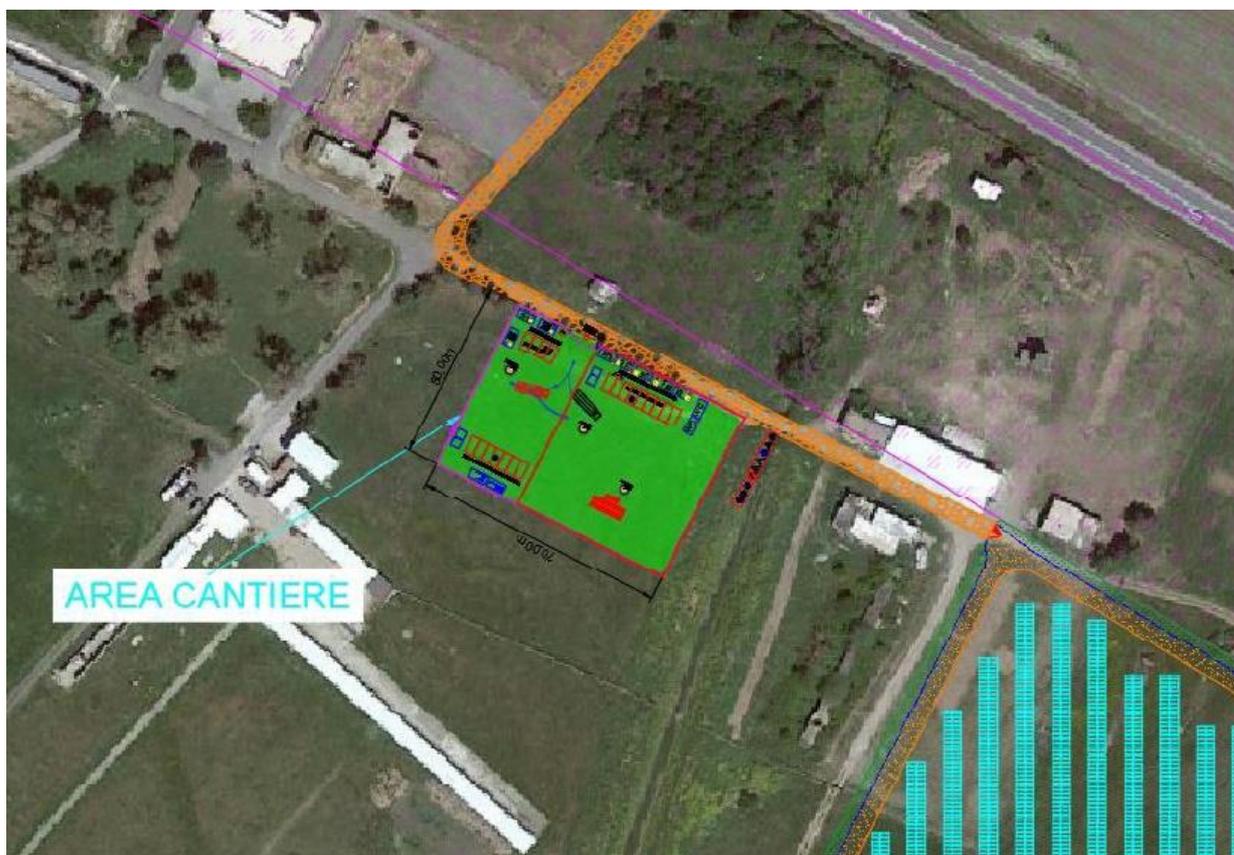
Stralcio su ortofoto con localizzazione della posizione dell'area temporanea di cantiere.
